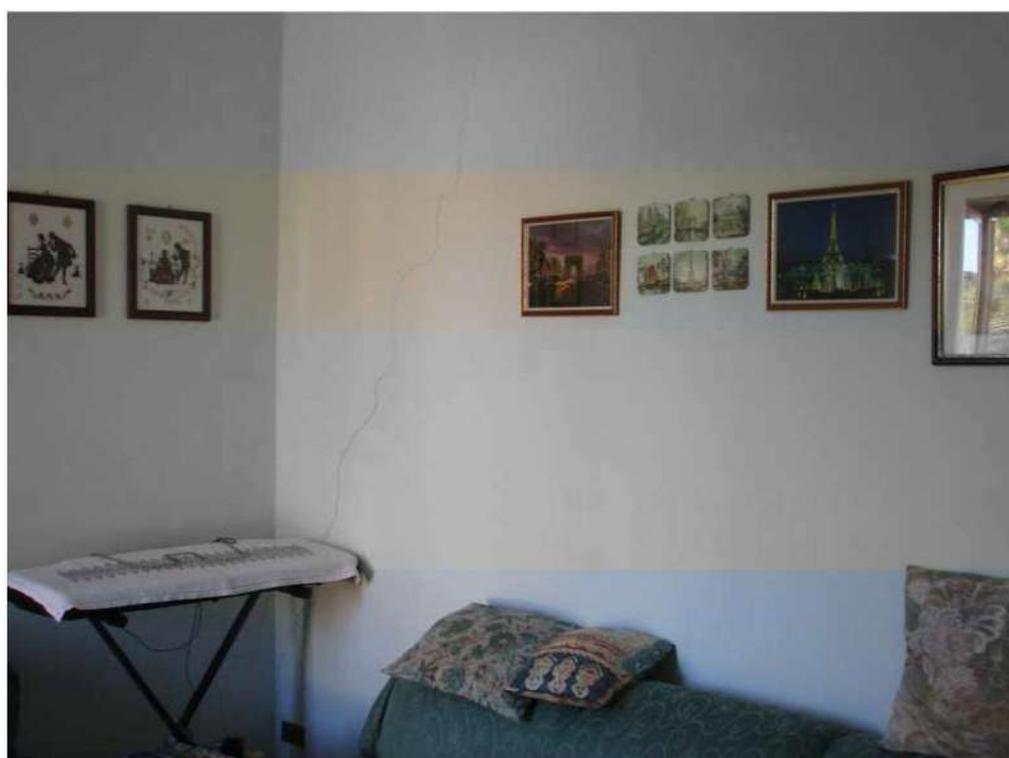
Uno dei vani interessati da fessurazioni sui paramenti verticali
